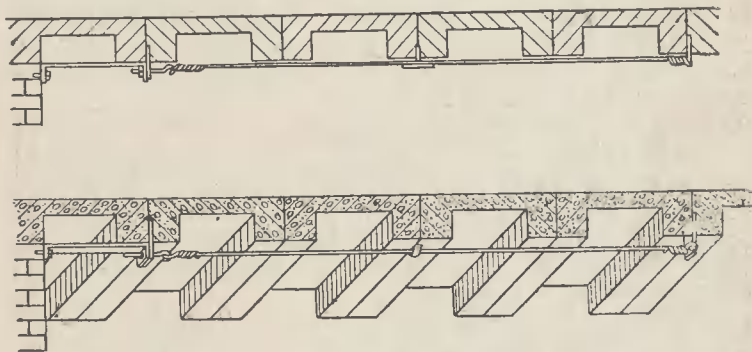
Способ крепления кабелей по натянутой струне по перекрытию с ребристыми плитами.
